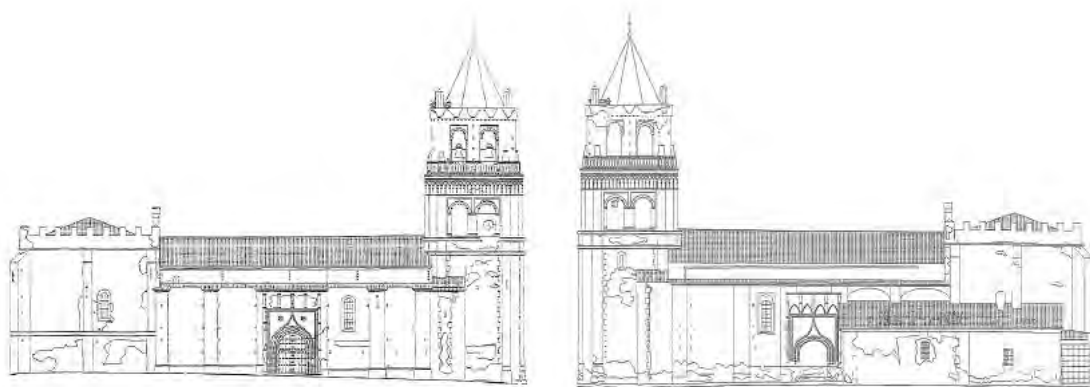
Alzados de las fachadas laterales antes de su restauración. Fuente: AMIGO MARCOS, R. J., Proyecto de Restauración de la Iglesia Parroquial de Palomas²⁶⁹.
